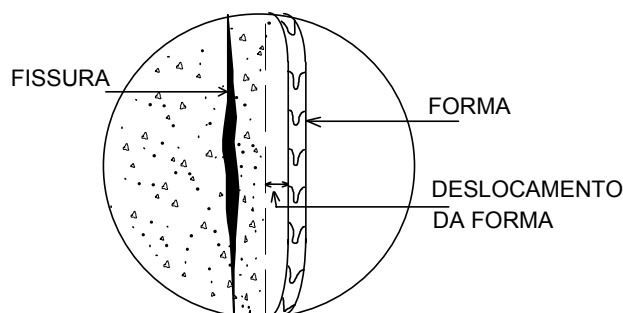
Fissura interna devido ao movimento da fôrma
